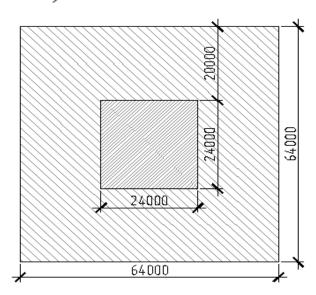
Площадь срезки растительного слоя почвы Разработка грунта под фундамент
